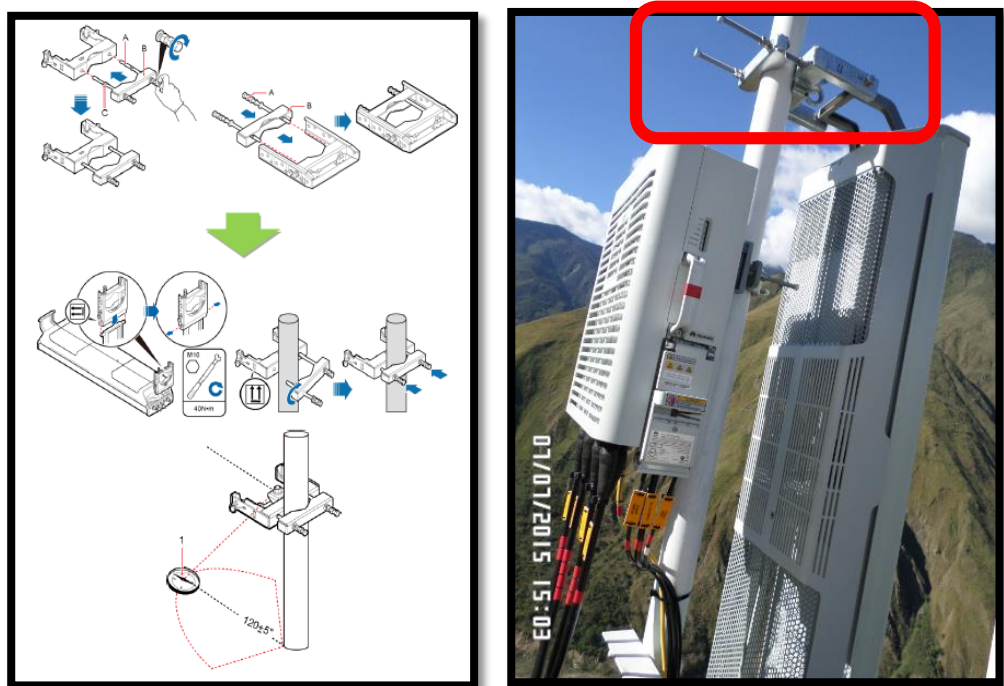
Tilt Mecánico, Site Santa Teresa
